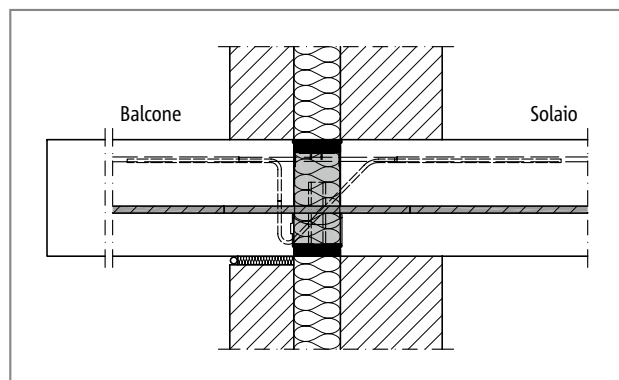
Schöck Isokorb® T tipo KL, HP-NN: muratura bistrato con interposto isolamento
